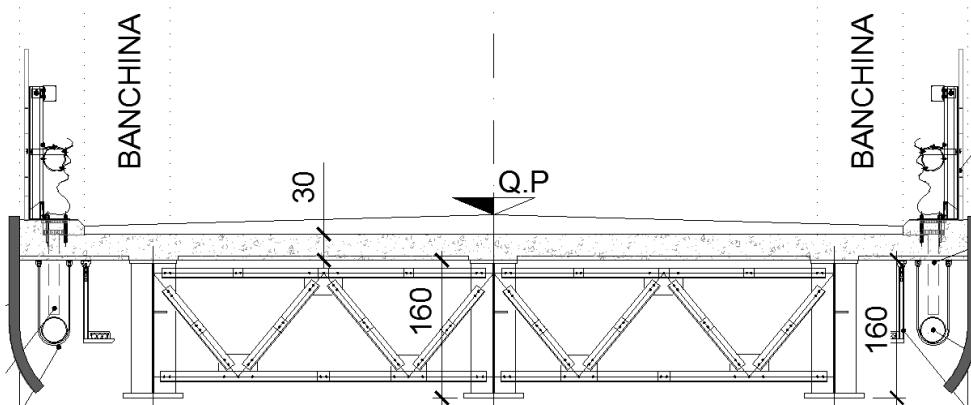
Sezione trasversale dell'impalcato campata centrale
